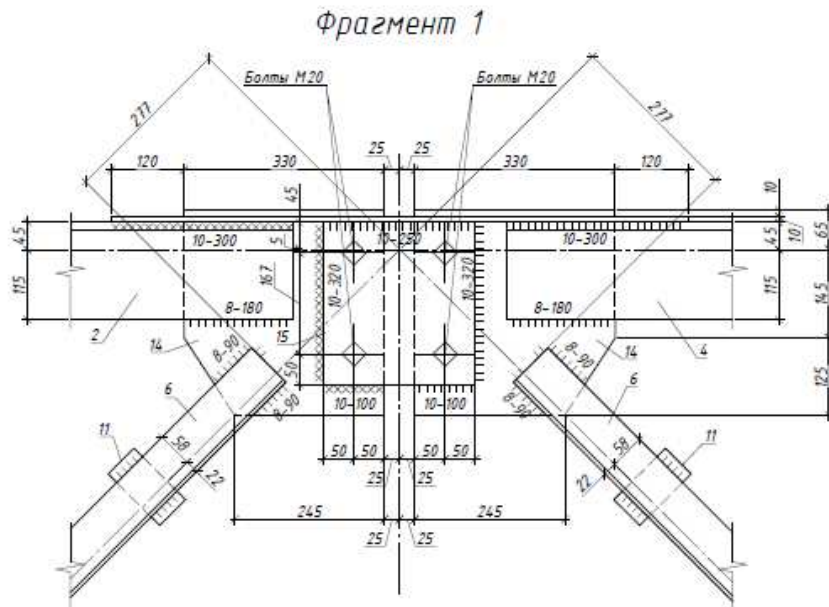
Узел сопряжения верхнего пояса фермы
